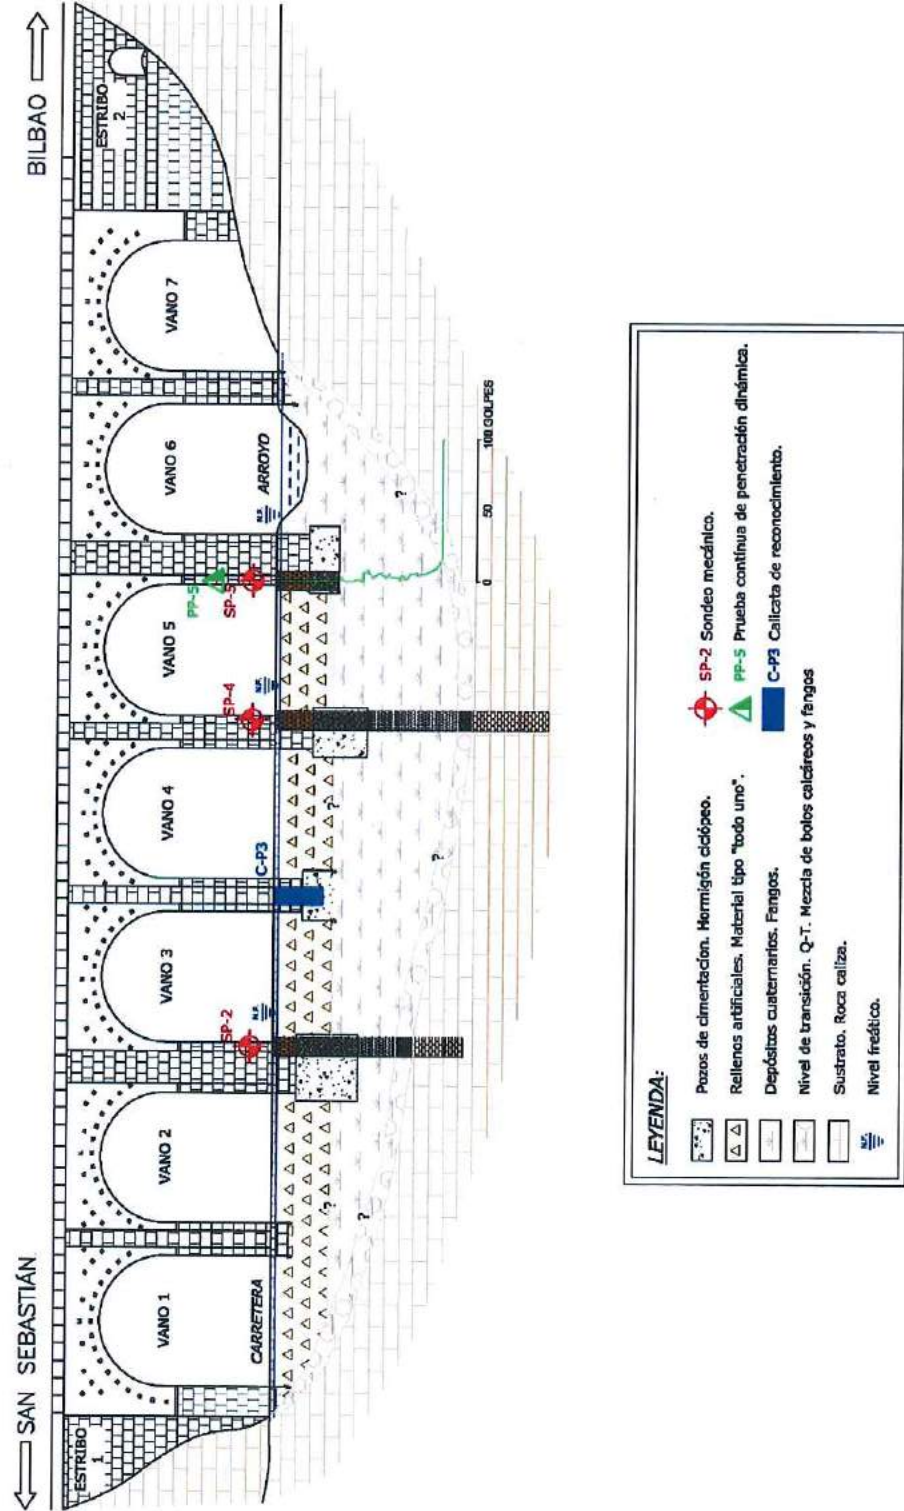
Alzado del puente y perfil geológico-geotécnico
